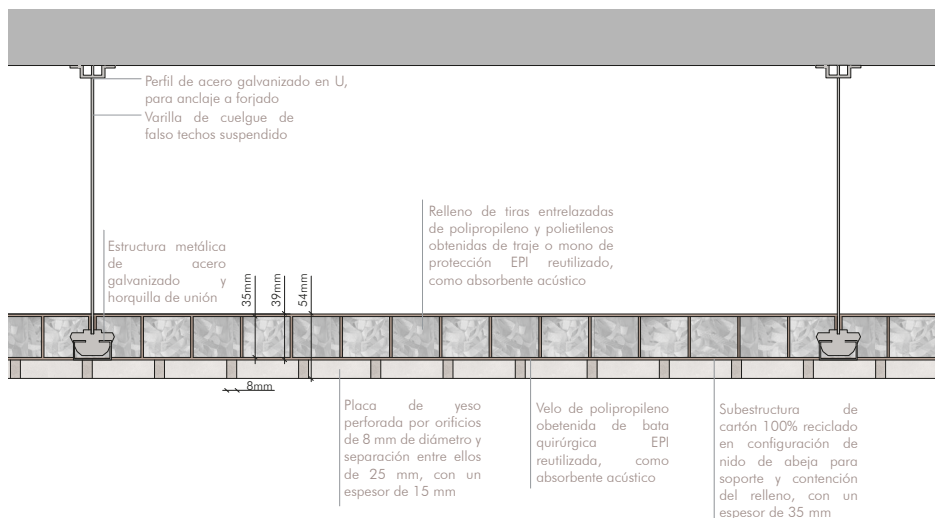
Detalle constructivo tipo del falso techo propuesto. Fuente: elaboración propia
